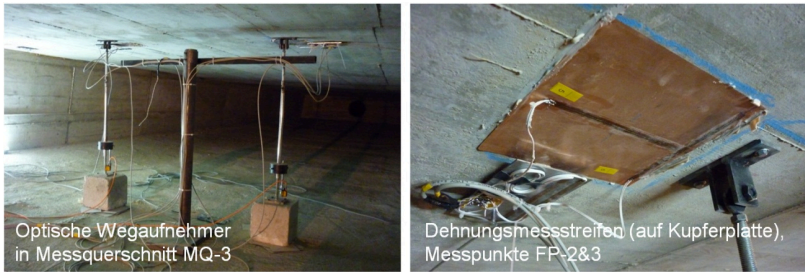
Innenansicht der Landstraßenbrücke in Rethen mit Messtechnik
